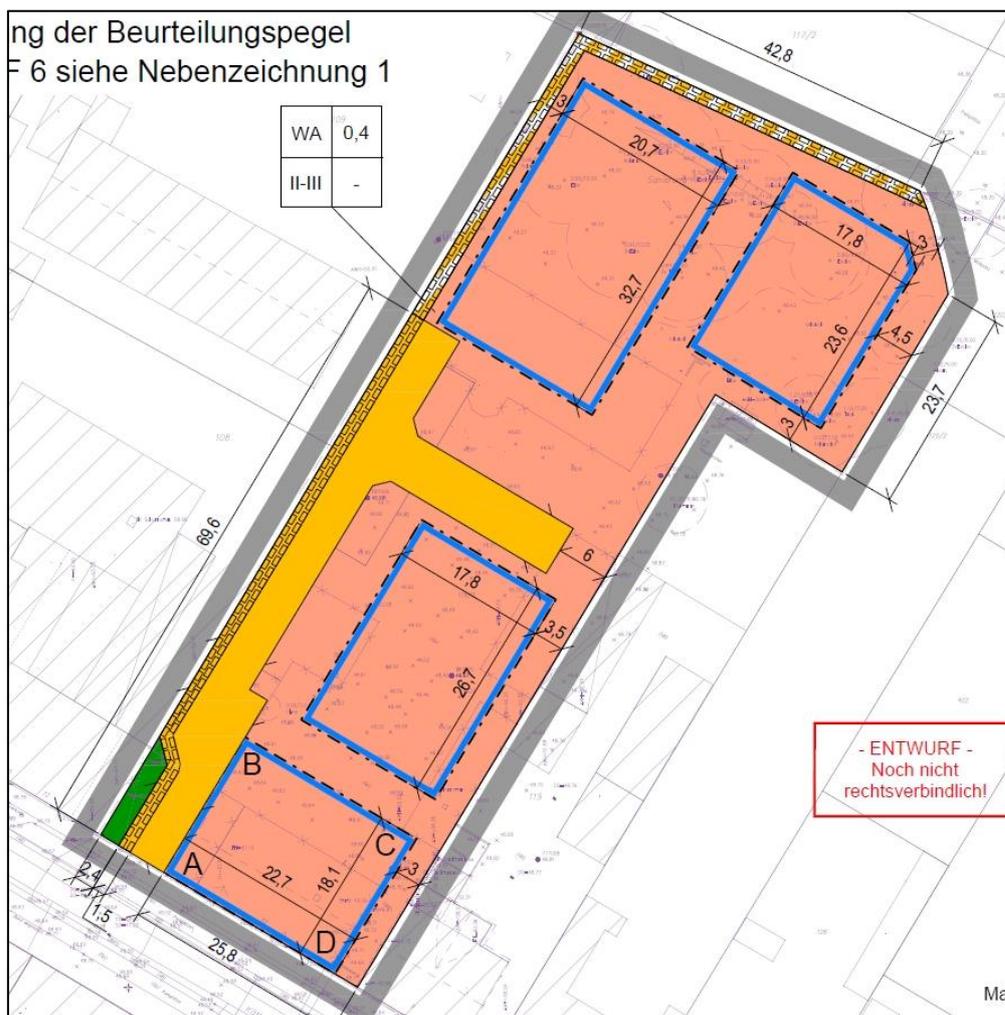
Ausschnitt aus der Planzeichnung des Bebauungsplans (Stand 14.10.2021)
